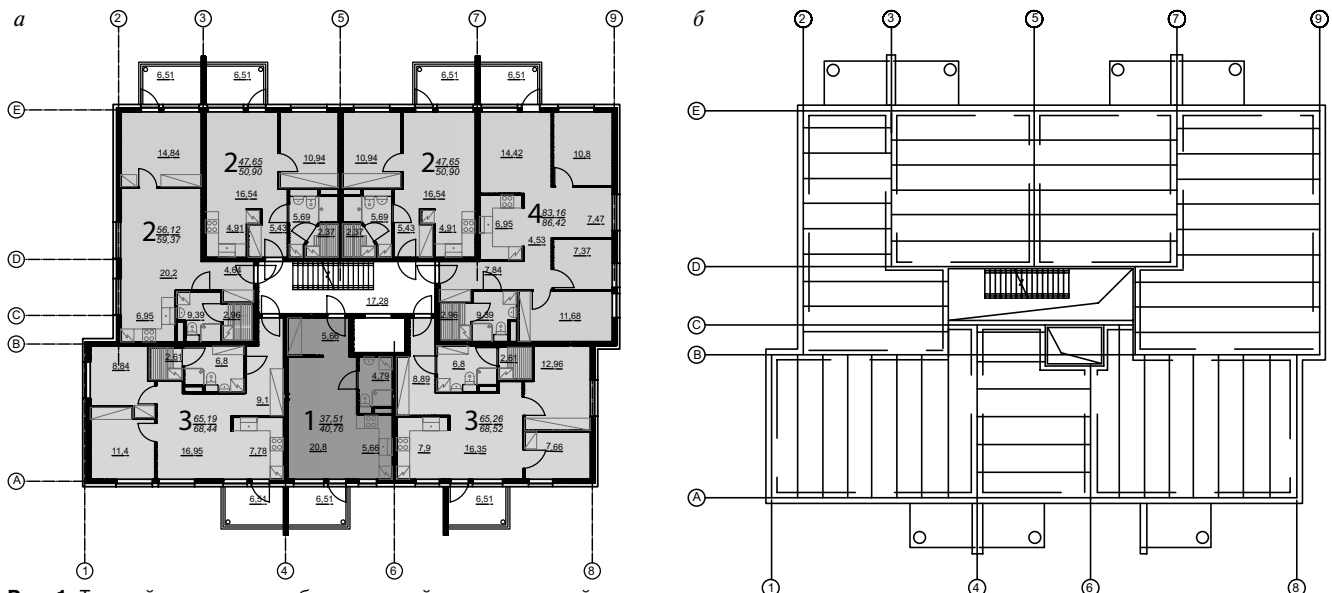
Типовой этаж: а – план; б – монтажный план перекрытий
